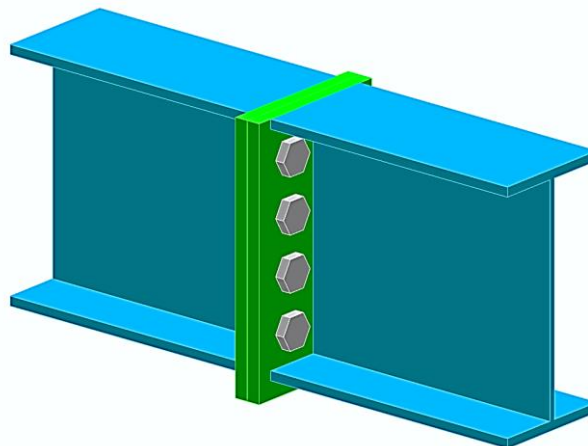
Vue 3D de l'assemblage Poutre-poutre
